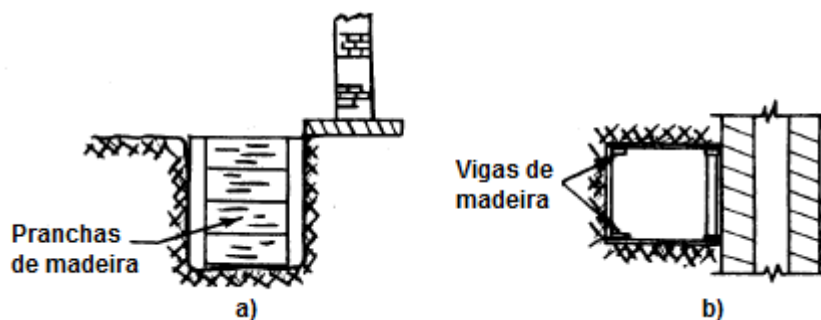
Execução do escoramento do antepoço: a) alçado; b) planta [32]
